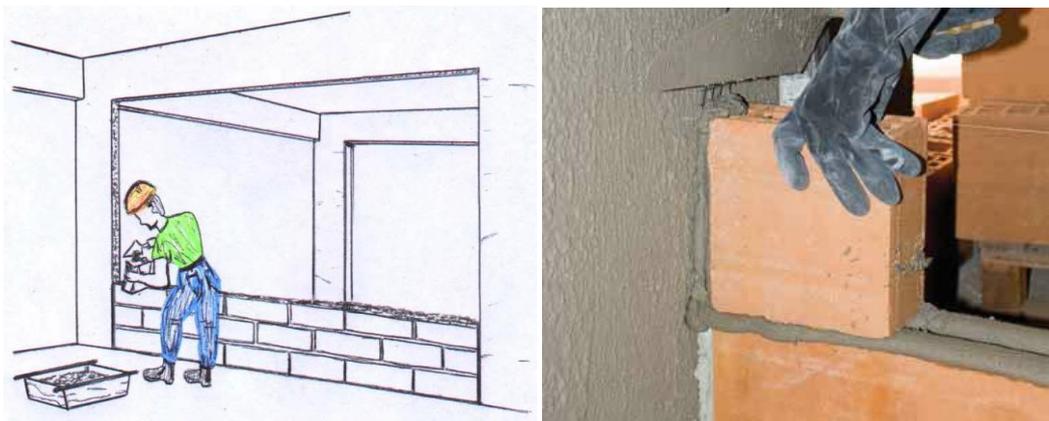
Assentamento do bloco da extremidade junto ao pilar
